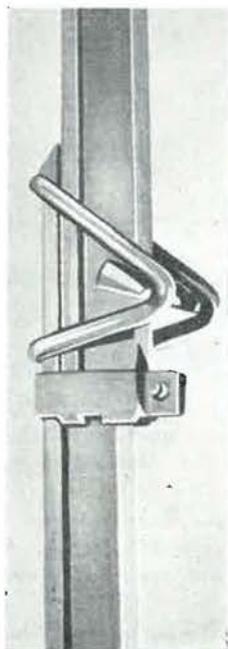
Assemblage de deux éléments Toussaint Heintzmann par clavette pivotante et pièce de guidage.
